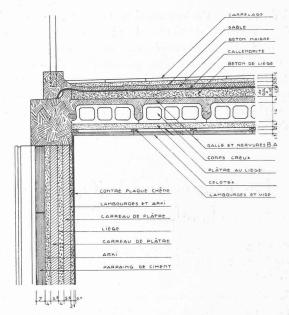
Coupe verticale d'un mur de façade et de la terrasse.
